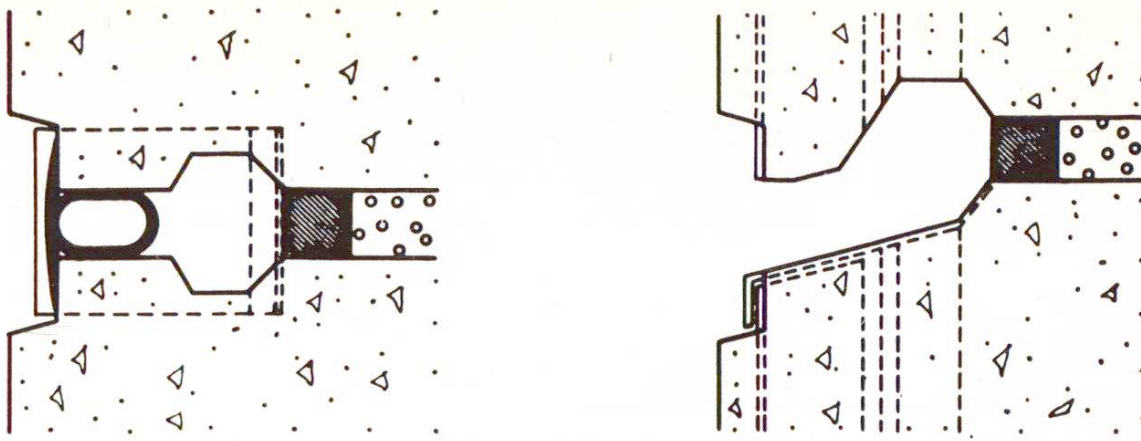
Joint à double étanchéité. A gauche joint vertical (étanchéité à l'eau de pluie au moyen d'un profilé élastique). A droite joint horizontal. Etanchéité au vent dans les deux cas au moyen d'un mastic.
